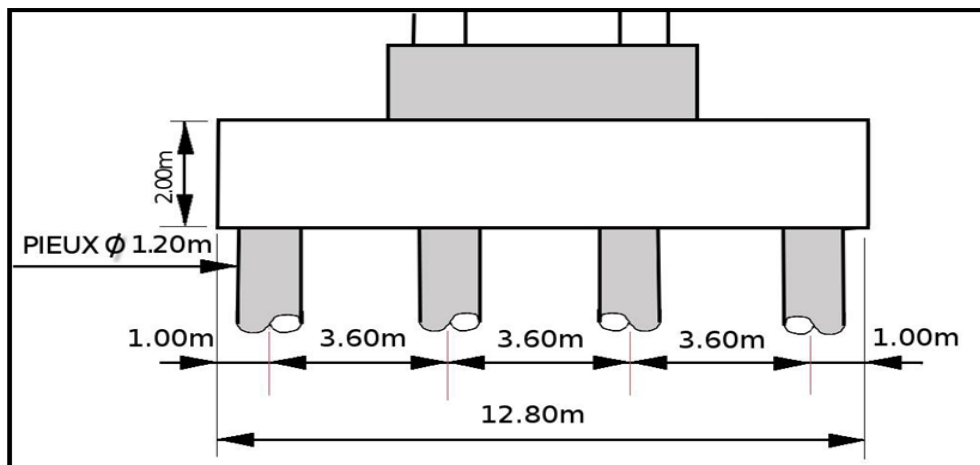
Disposition des pieux au niveau des piles (vue en plan).
